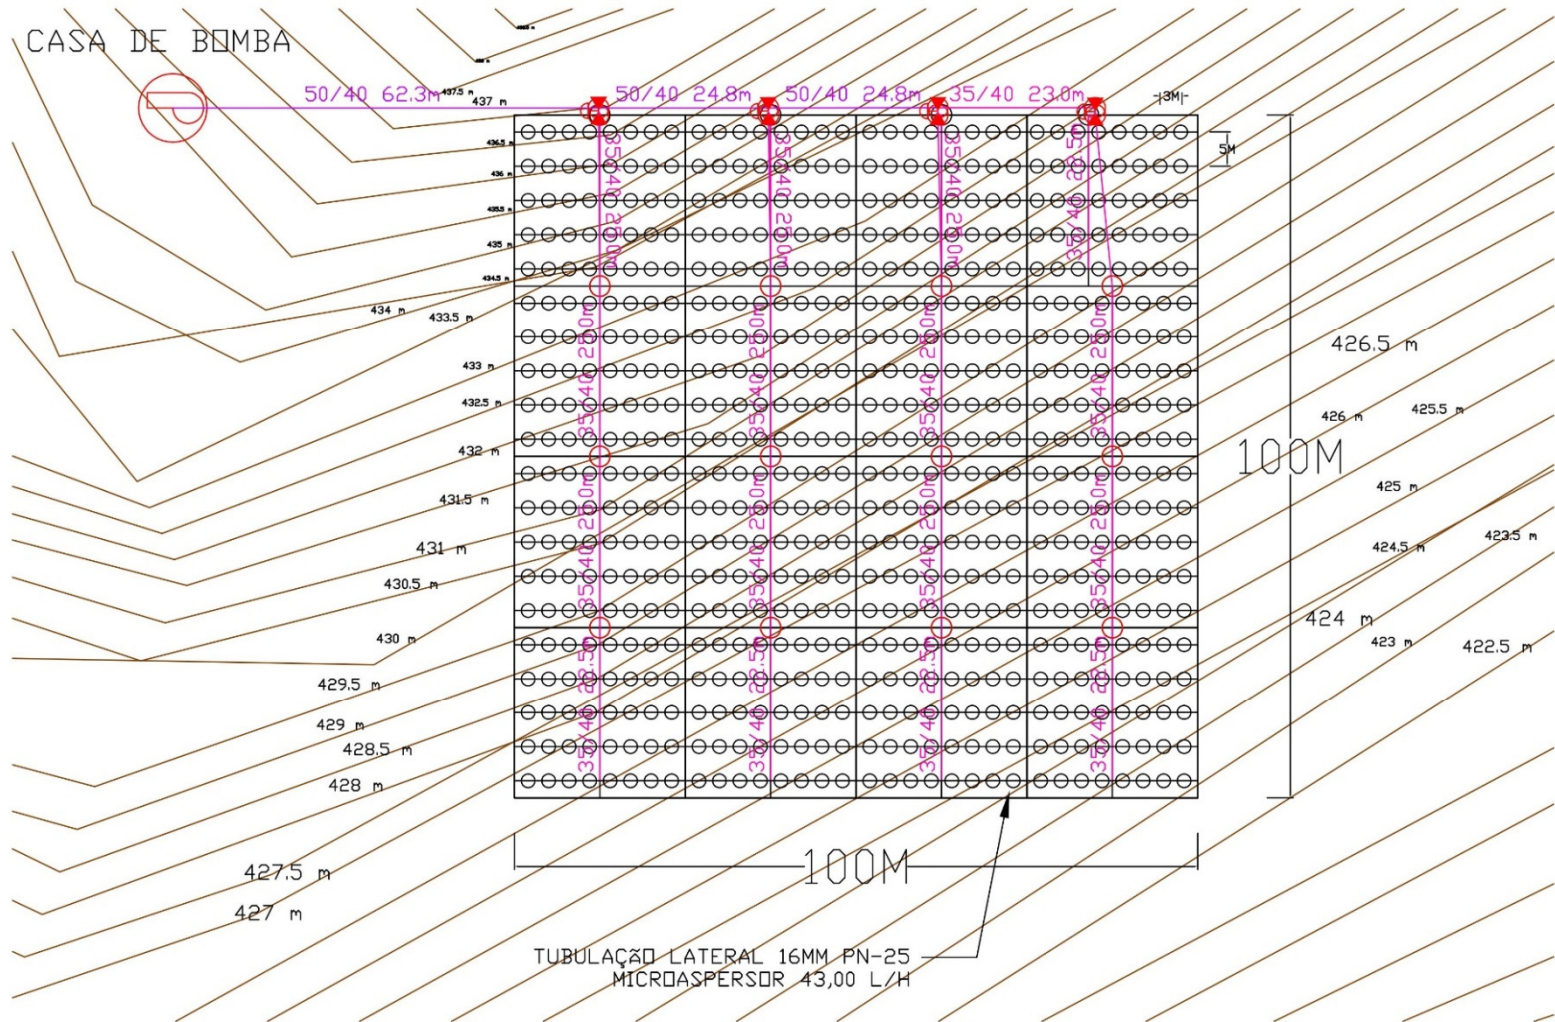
B – Detalhamento do projeto 4 (layout gerado pelo IrrigaCAD).
